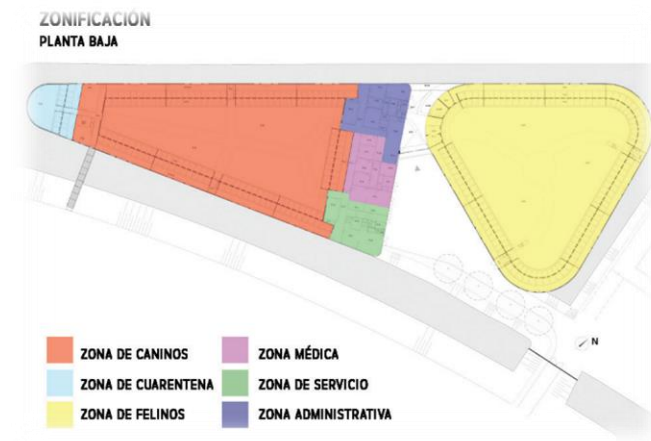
4. Análisis de Zonificación Planta Baja del Animal Refuge Centre
